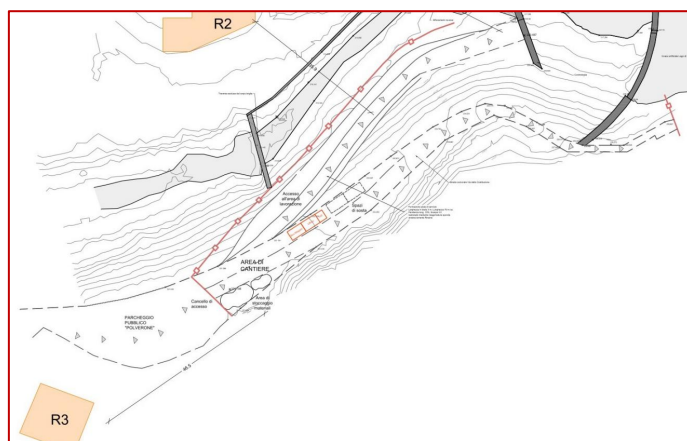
Interventi in progetto, Area di cantiere (vedi LON.PD.TAV.SP.05_Planimetria Assetto Cantiere 09.2023 Rev2)
